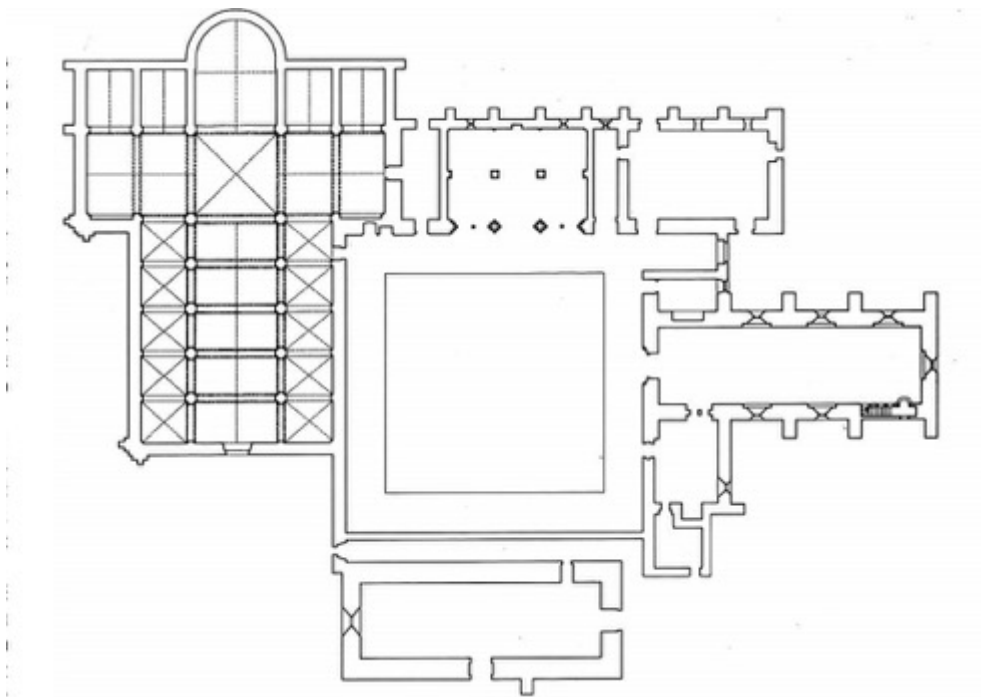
Óvila, Santa María, Grundriss Gesamtanlage, Ende 12./Anfang 13. Jhdt.
